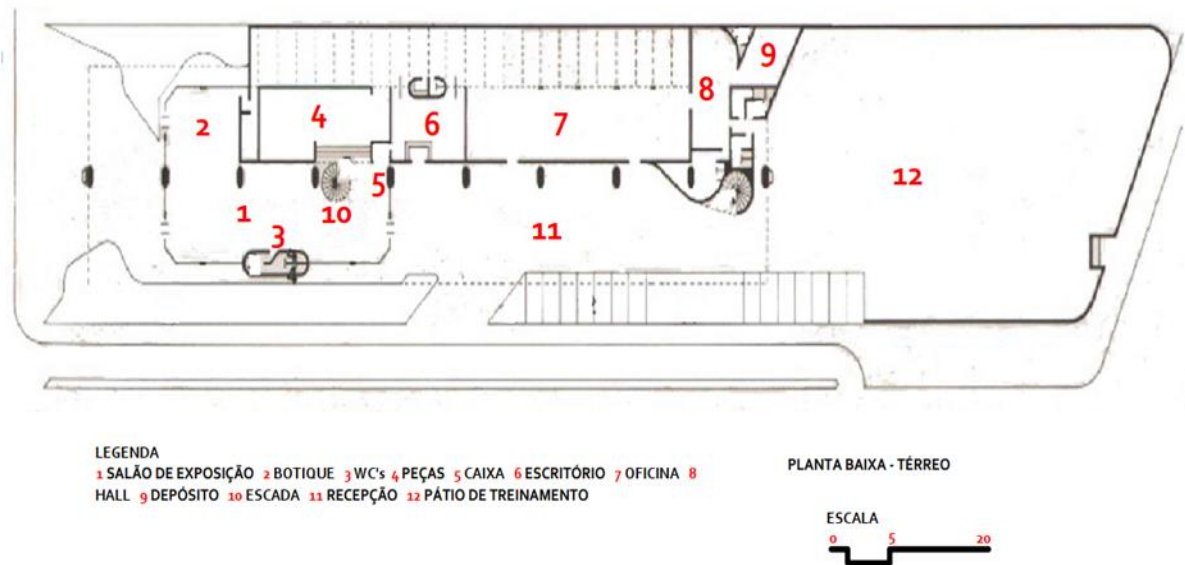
Planta Baixa - Térreo. Fonte: Acervo Pontual Arquitetos, adaptado pelo autor, 2020.
